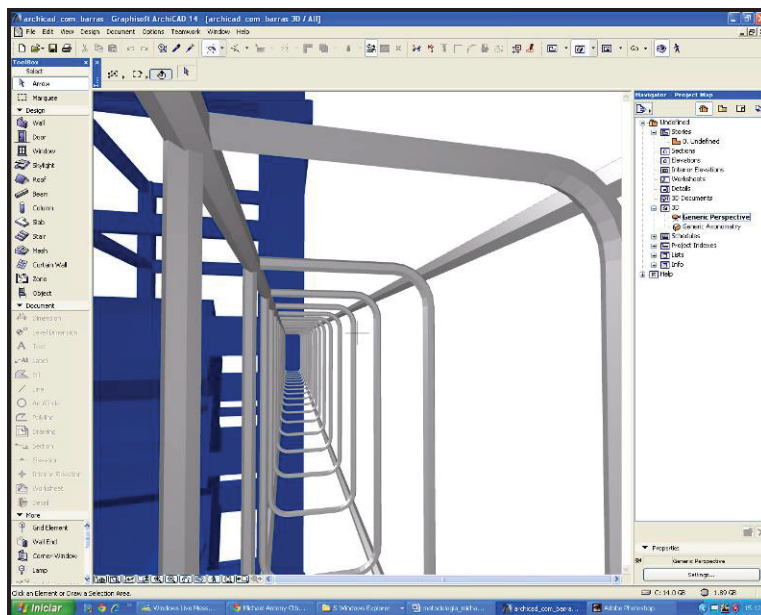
ARMADURAS IDENTIFICADAS NO ARCHICAD 14
